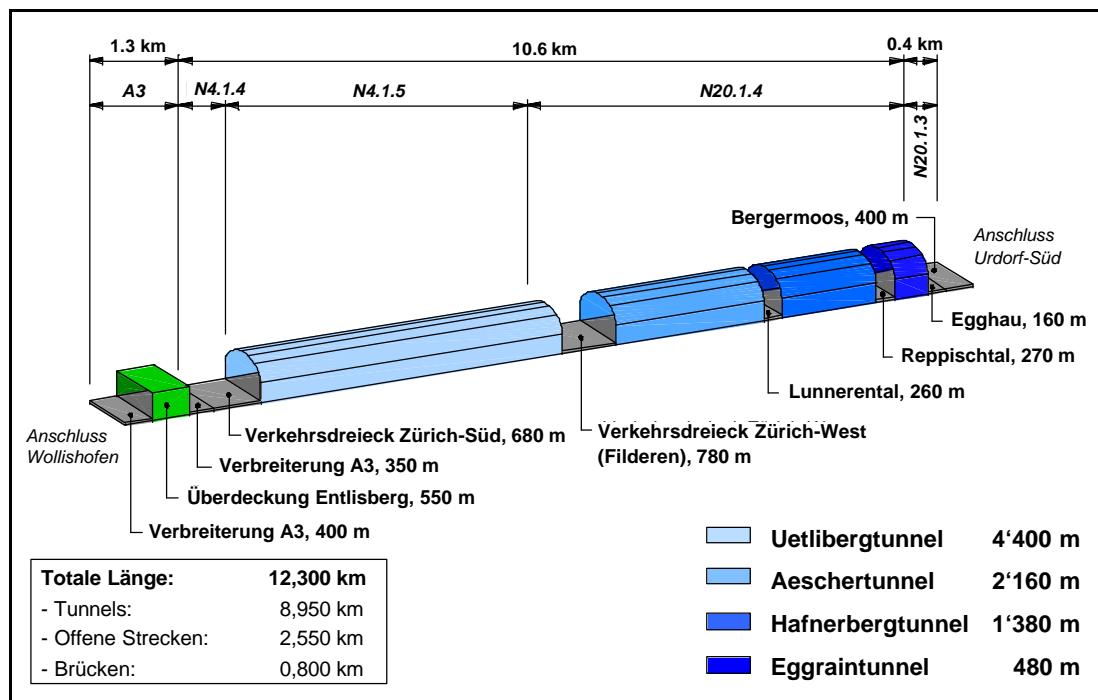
Bild C: Streckencharakteristik der Westumfahrung von Zürich
